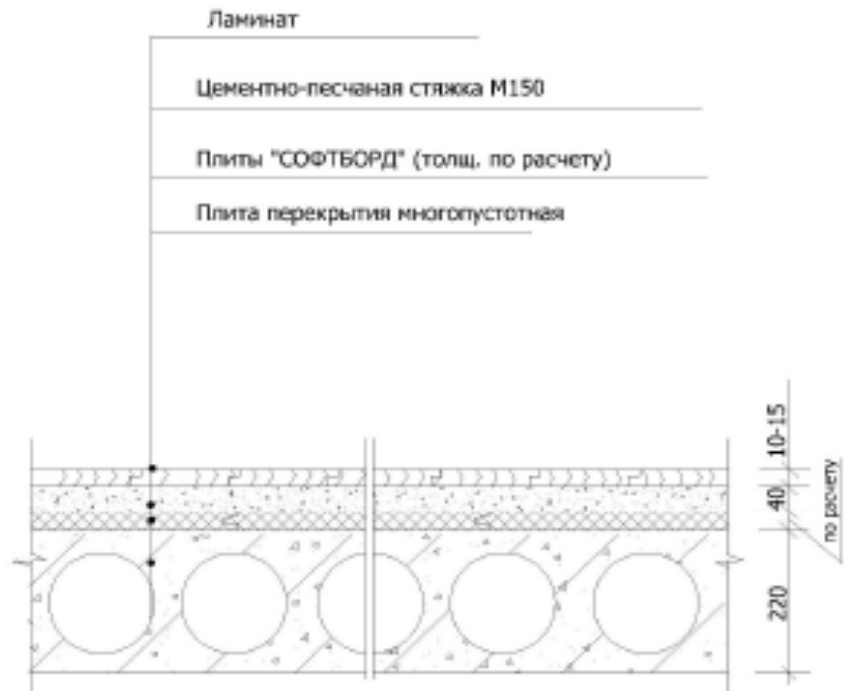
Применение плит СОФТБОРД в полах междуэтажного перекрытия из многослойных плит
